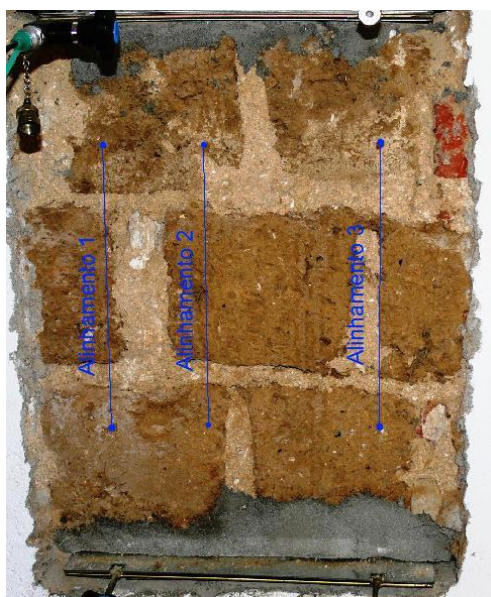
Alinhamentos verticais da janela 1 (Santarém)
